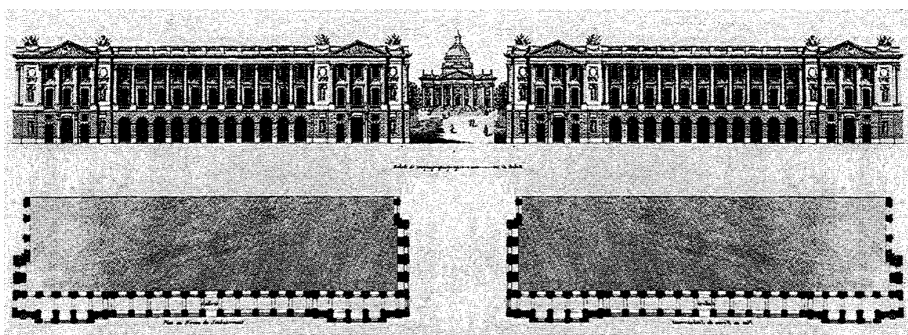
Le due facciate di Place Louis XV e la chiesa della Madeleine di Pierre Contant d'Ivry, da un disegno di Pierre Patte⁴¹.
